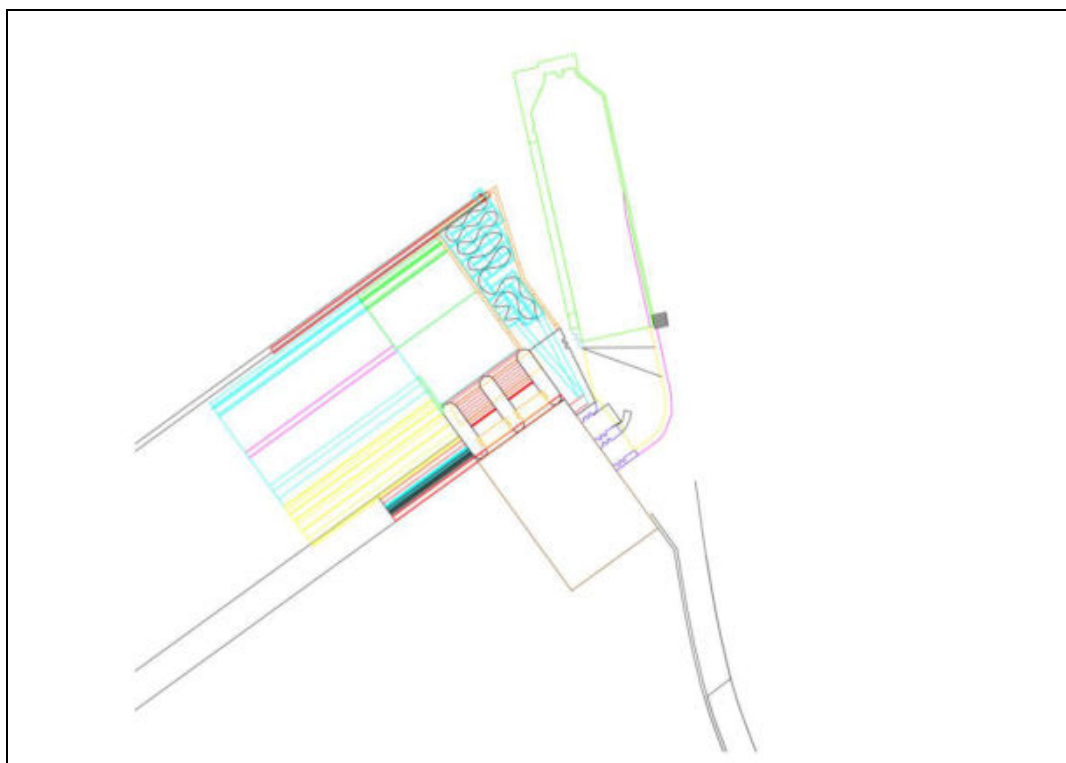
planimetria dell'inserimento del nuovo passaggio per pesci
